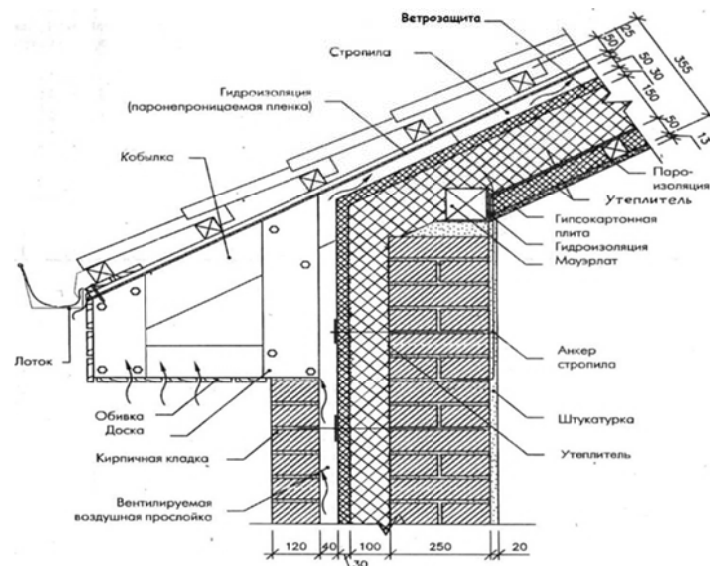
Карнизный узел соединения вентилируемой скатной крыши с вентилируемой трехслойной кирпичной стеной (мансардный этаж)
